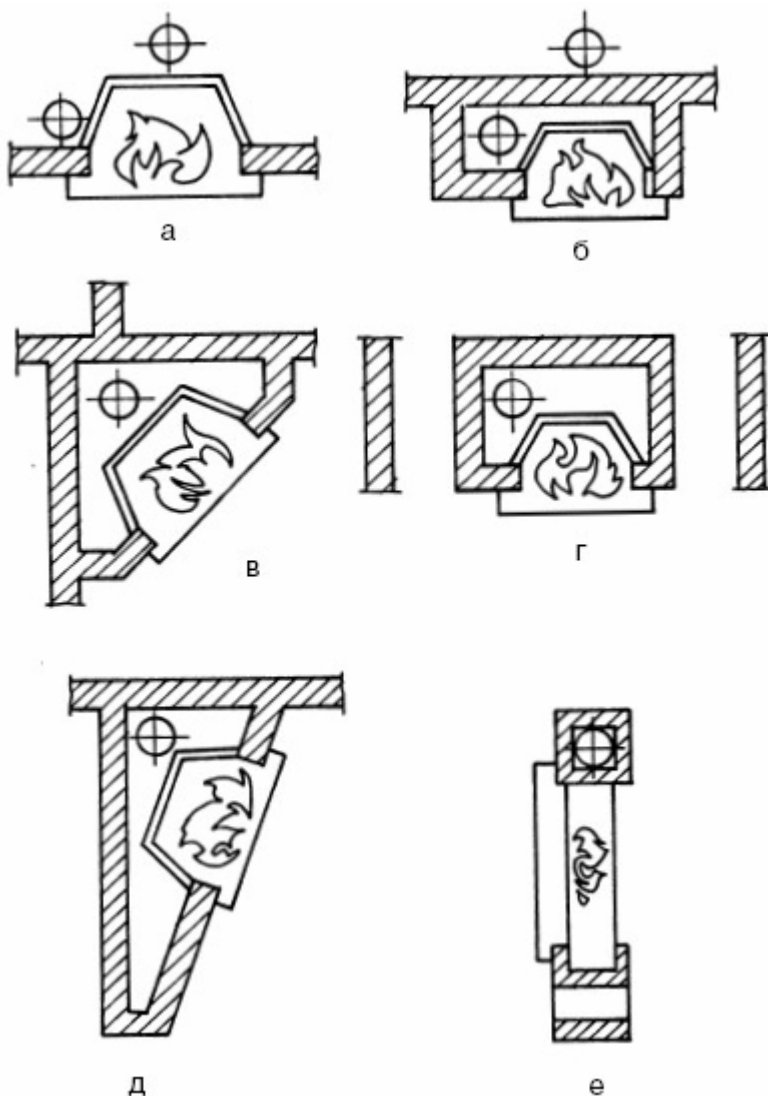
Варианты размещения каминов: а – встроенный в стену; б – пристенный; в – угловой; г – встроенный в перегородку; д – встроенный камин, выполняющий роль перегородки; е – отдельно стоящий камин
